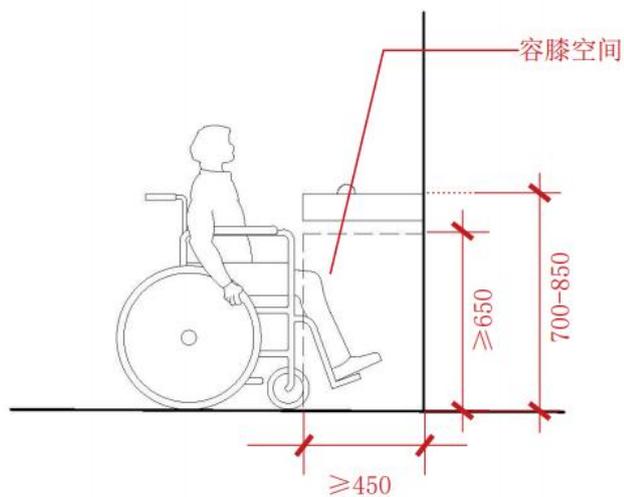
低位饮水处示意图 (单位: mm)
